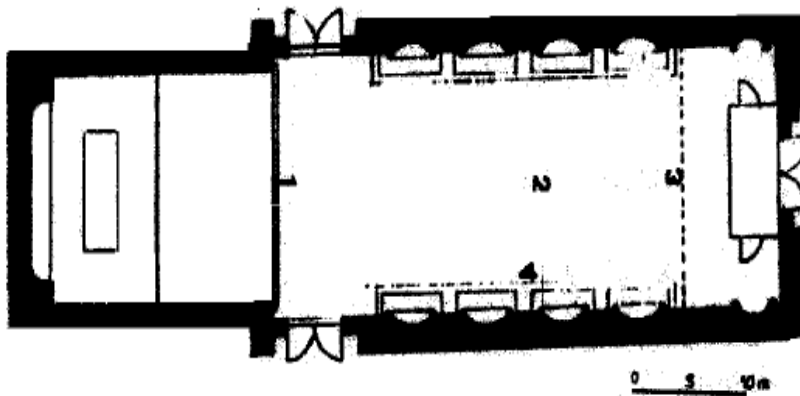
Planta da igreja da Lapa (Porto) [3]
